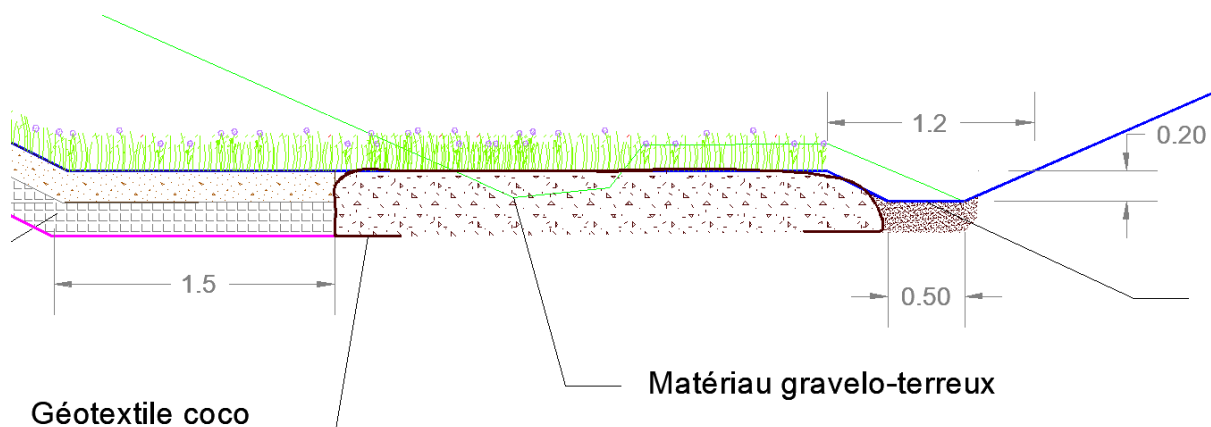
Zoom sur le profil type au niveau de la banquette « libre »
